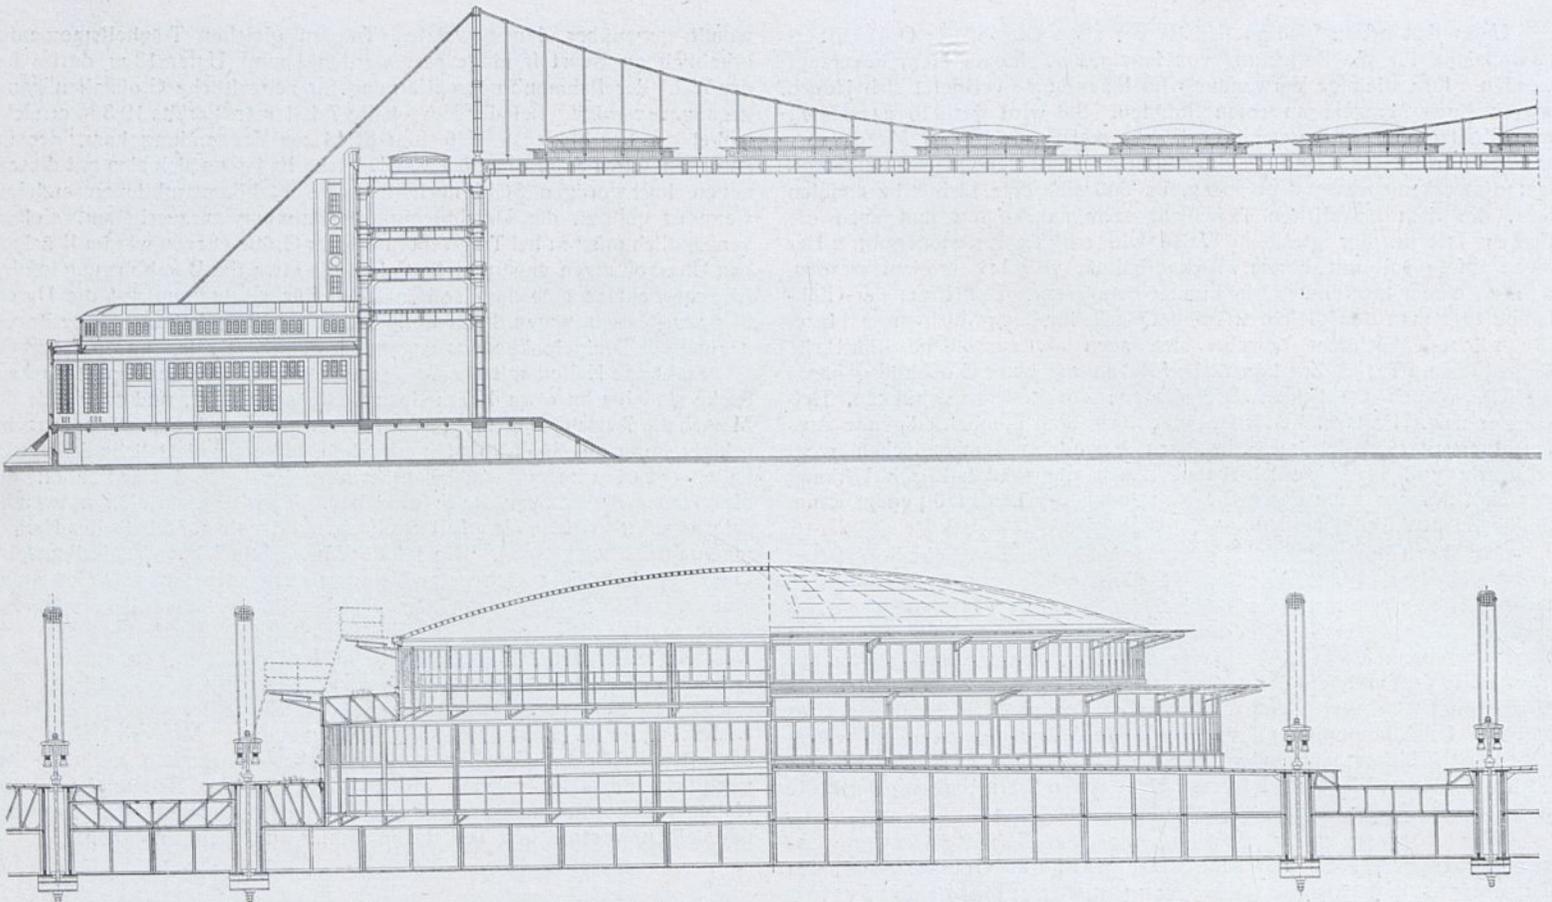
Entwurf Bousterin für die Pariser Ausstellungshalle.
